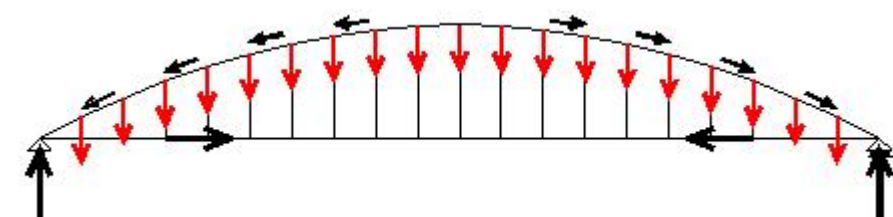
Comportamiento resistente puente arco atirantado tipo bowstring
